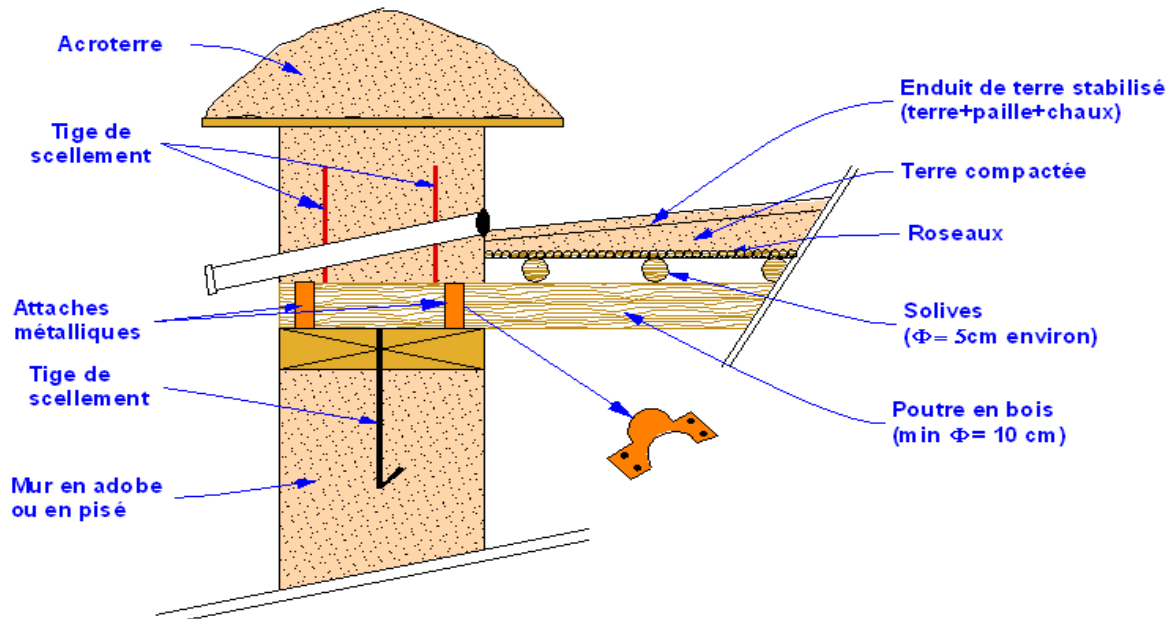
Chaînage horizontal en bois, toiture traditionnelle et attache mur - chaînage
